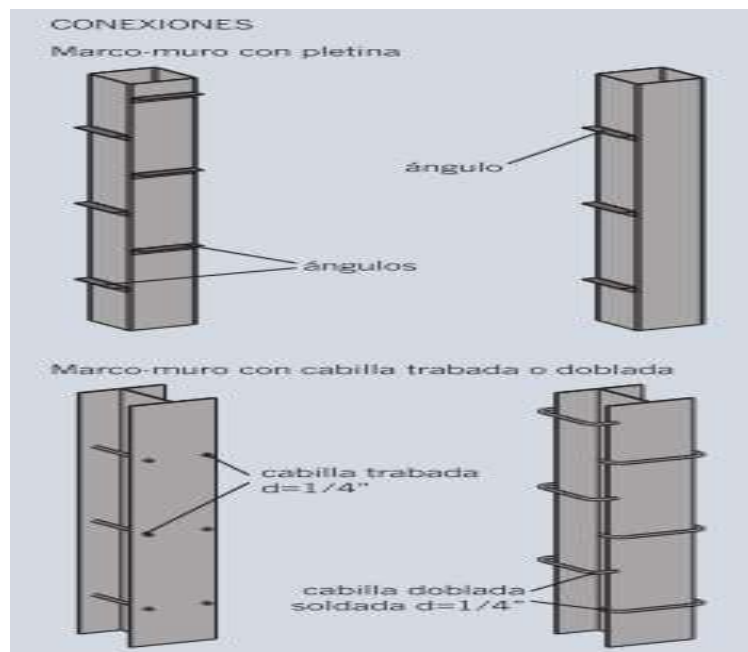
Tipo de conexiones marco-muro (Acosta [15]).
